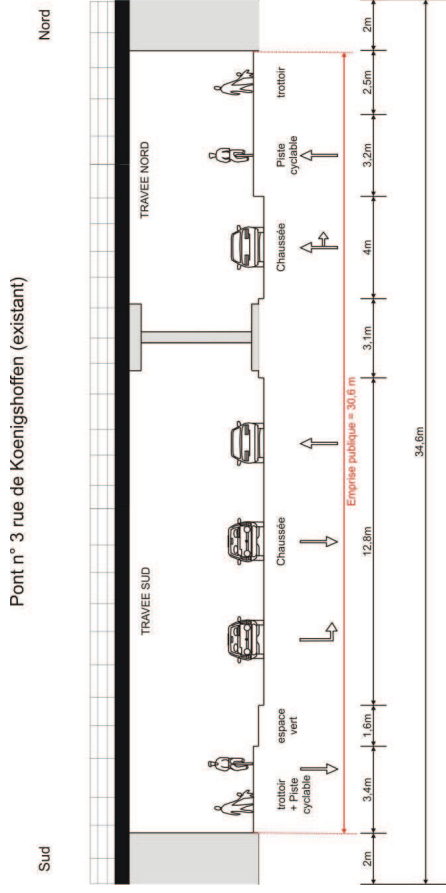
Situation existante coupe 33 sur la rue de Koenigshoffen
